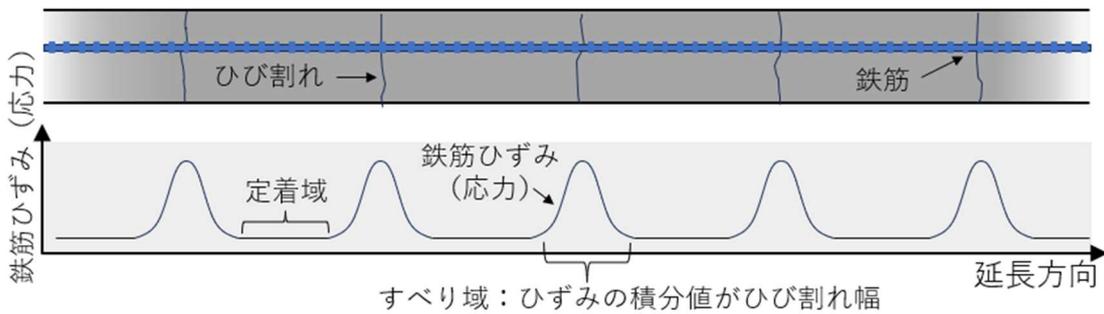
CRCP のひび割れと鉄筋ひずみ（または鉄筋応力）分布のイメージ
